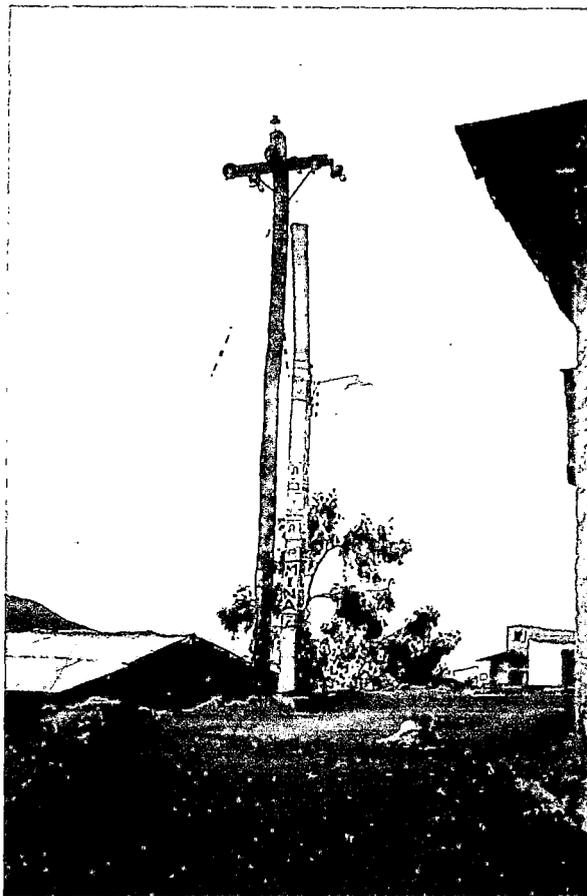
Cableado del servicio eléctrico de la localidad de Congas.
